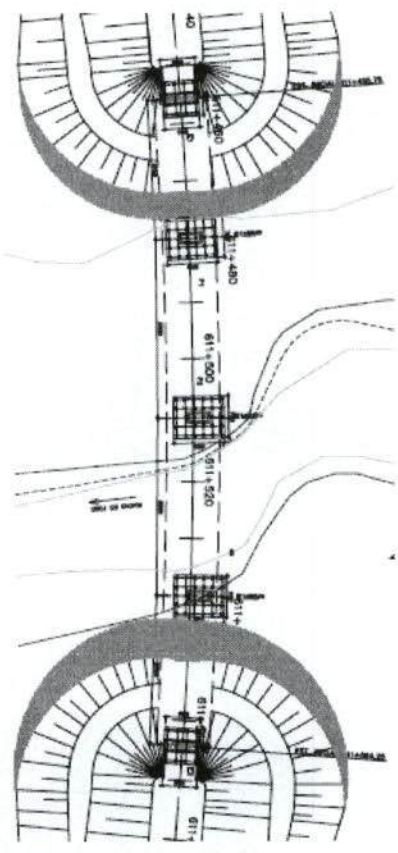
Projeto da ponte sobre o Riacho do Fogo (planta de situação)
